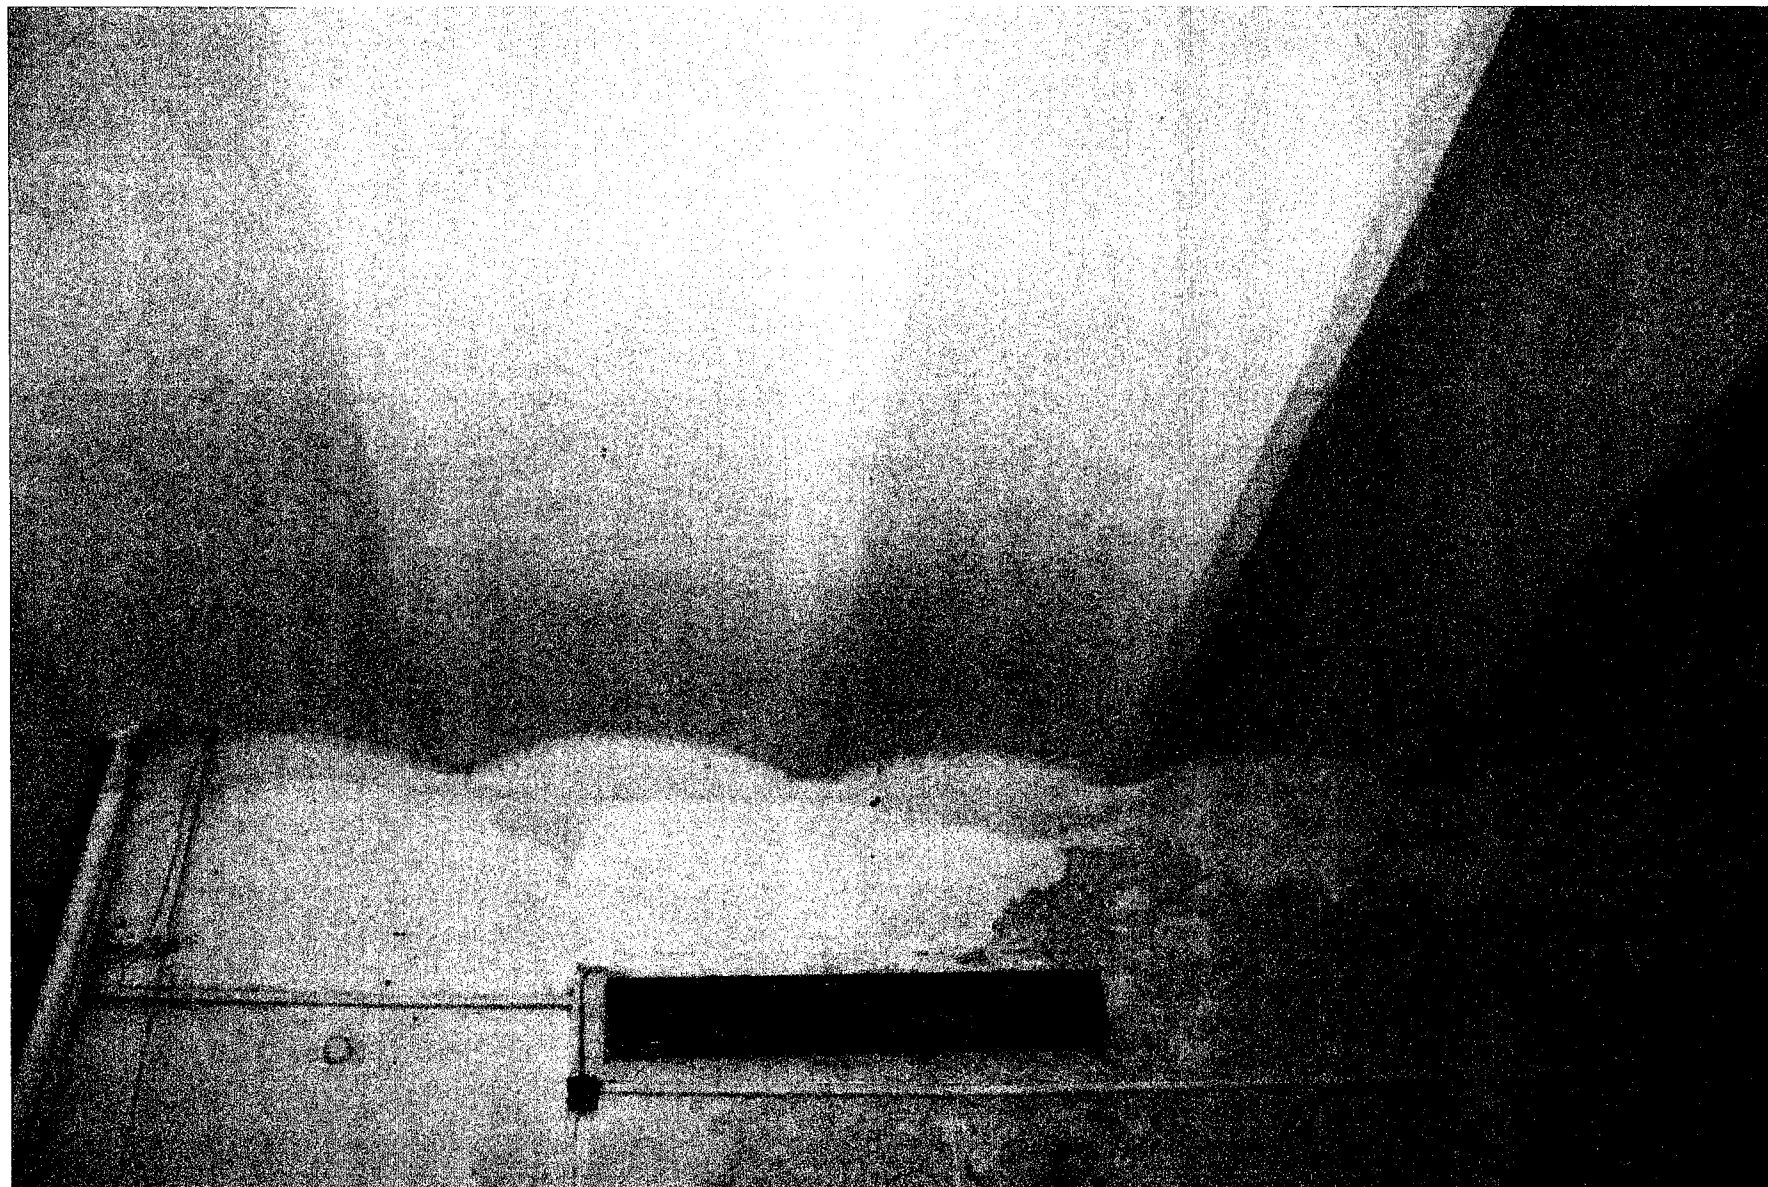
Фрагмент интерьера. Сводчатые перекрытия
